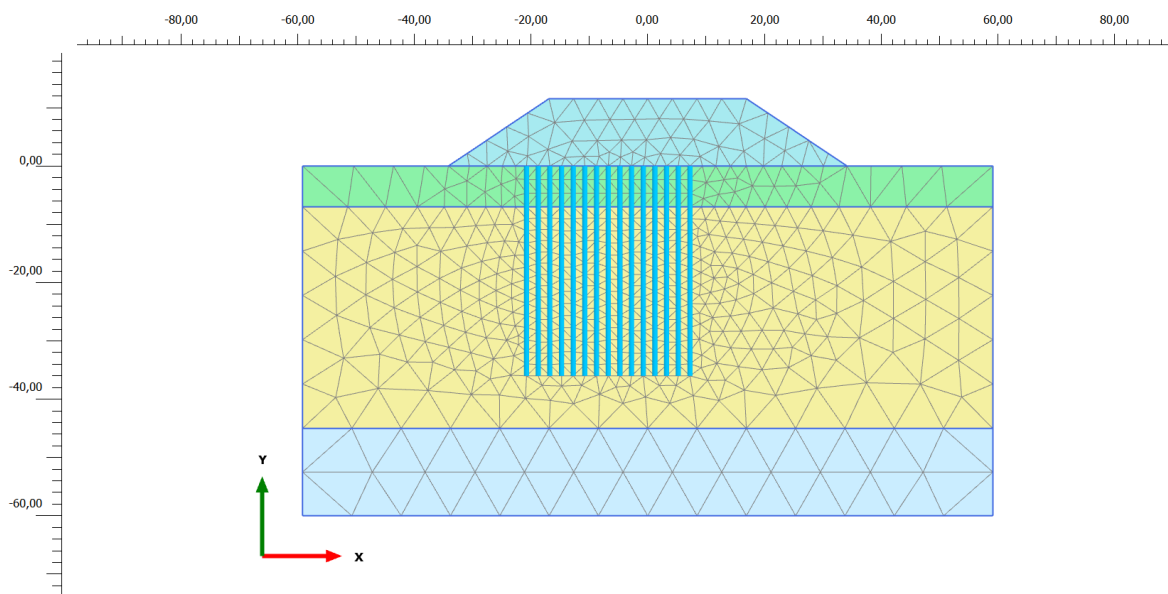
rilevato B – costruzione del rilevato di precarica
